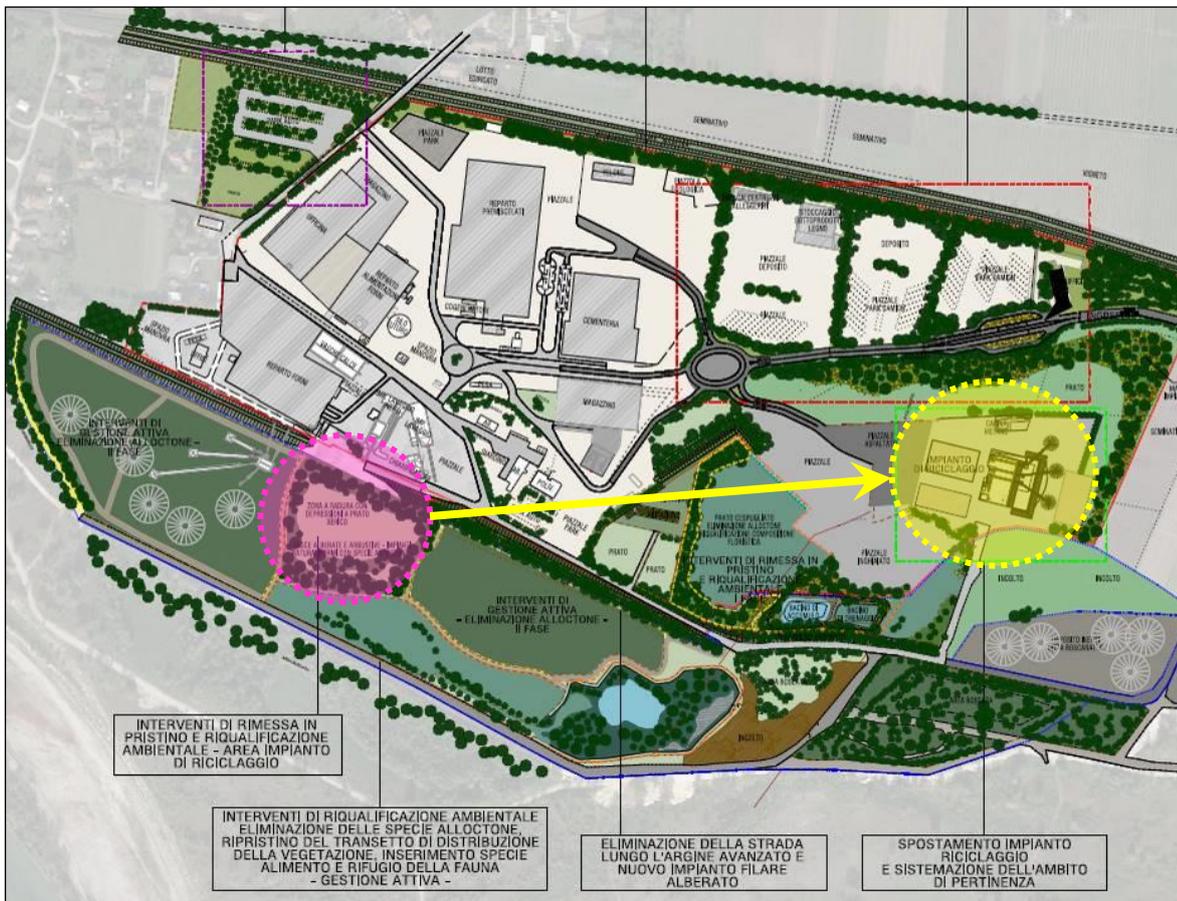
Estratto della Planimetria generale degli interventi con indicazione della ricollocazione dell'impianto di riciclaggio
